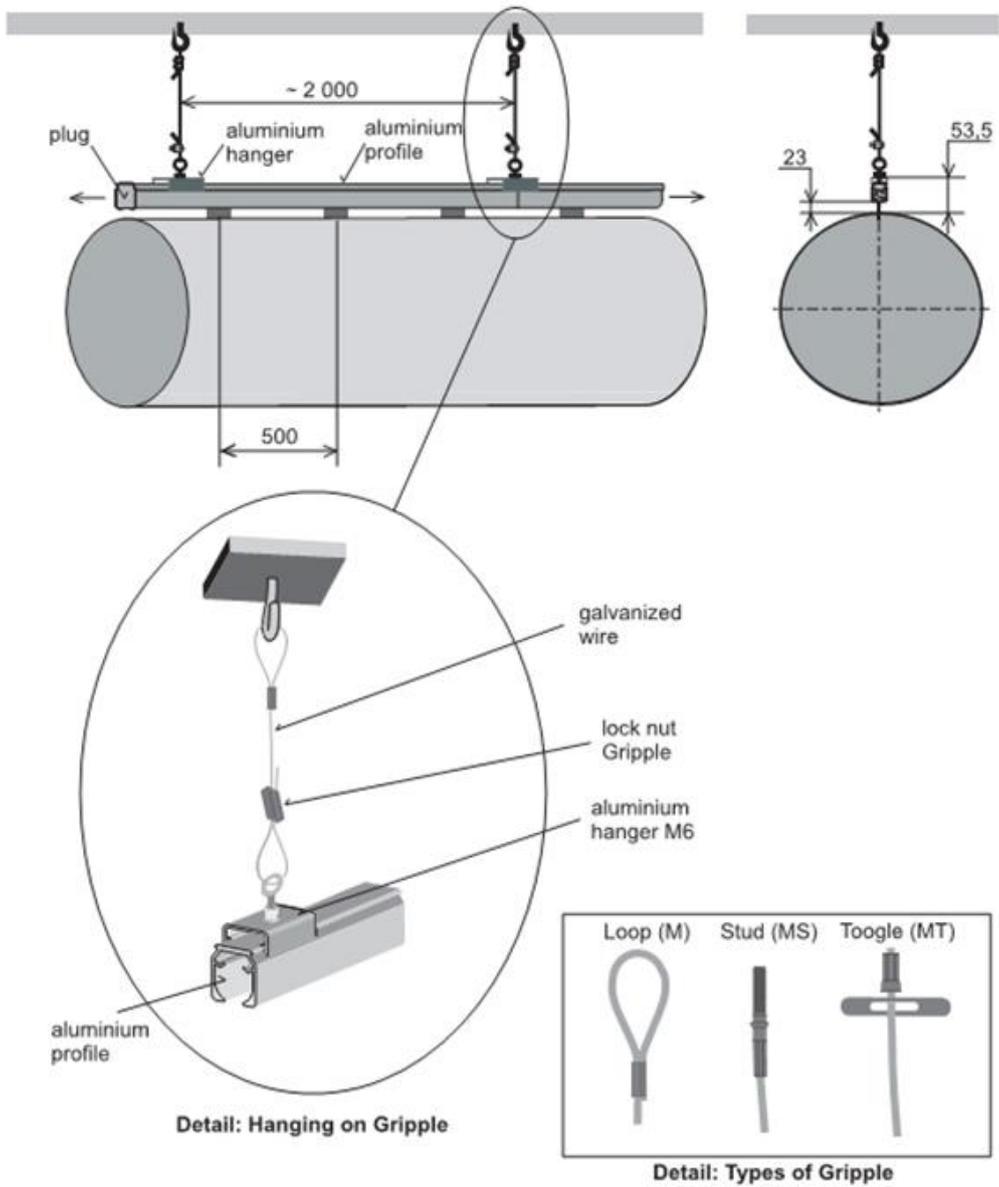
Conductos fijados sobre perfil de aluminio (fuente: Priboda).
